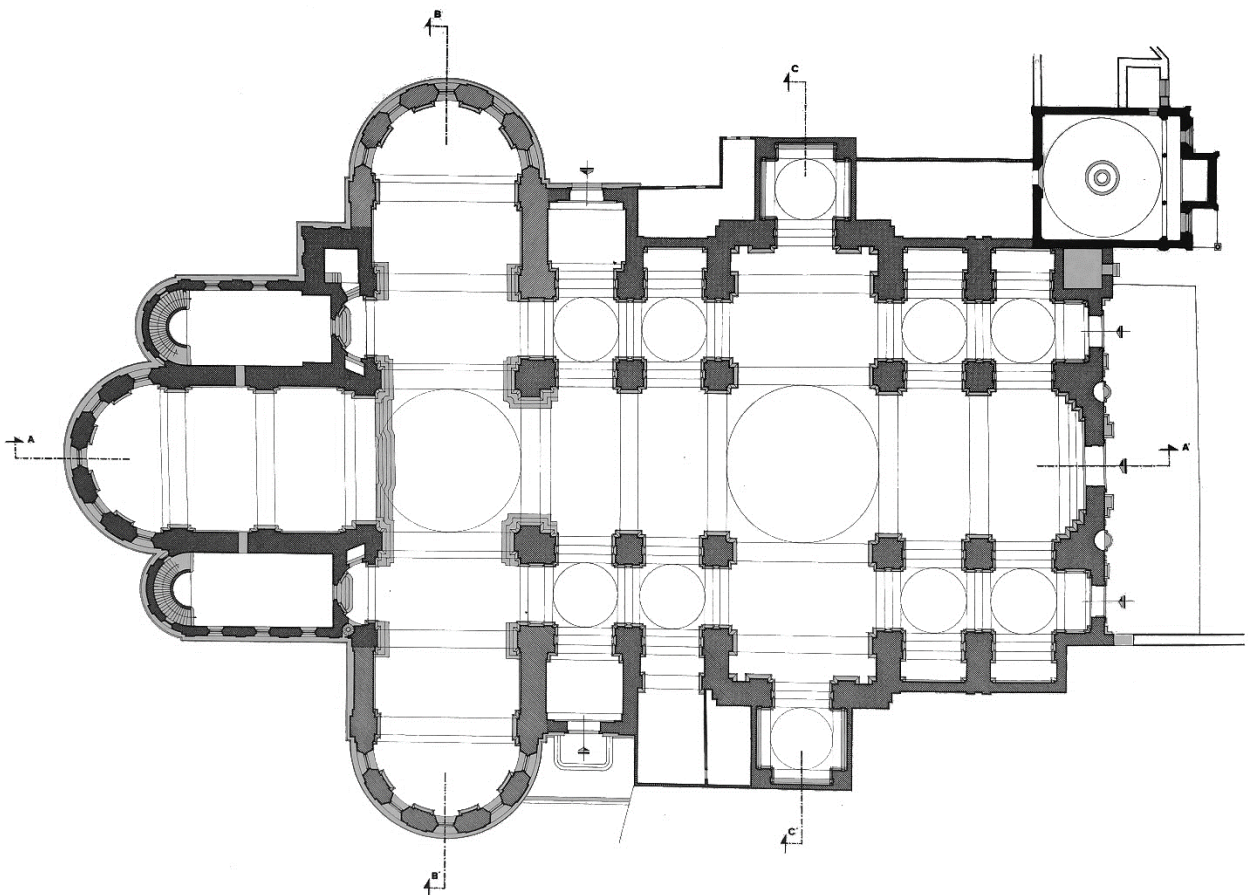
Planimetria attuale della Cattedrale di Santa Maria Assunta (Bresciani Alvarez, 1966)
